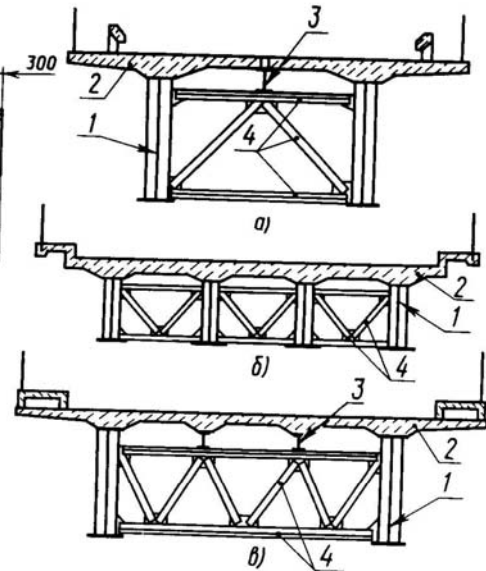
Поперечные разрезы автодорожных пролетных строений с железобетонной плитой
